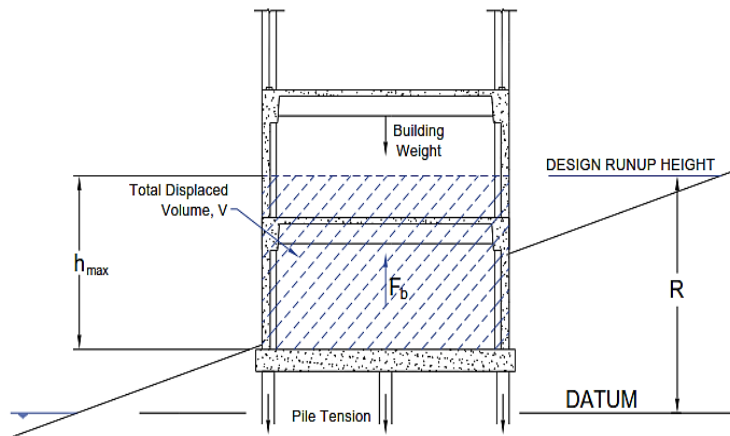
Définition de la poussée ascendante exercée sur un plancher (Heintz and Mahoney, 2008).
